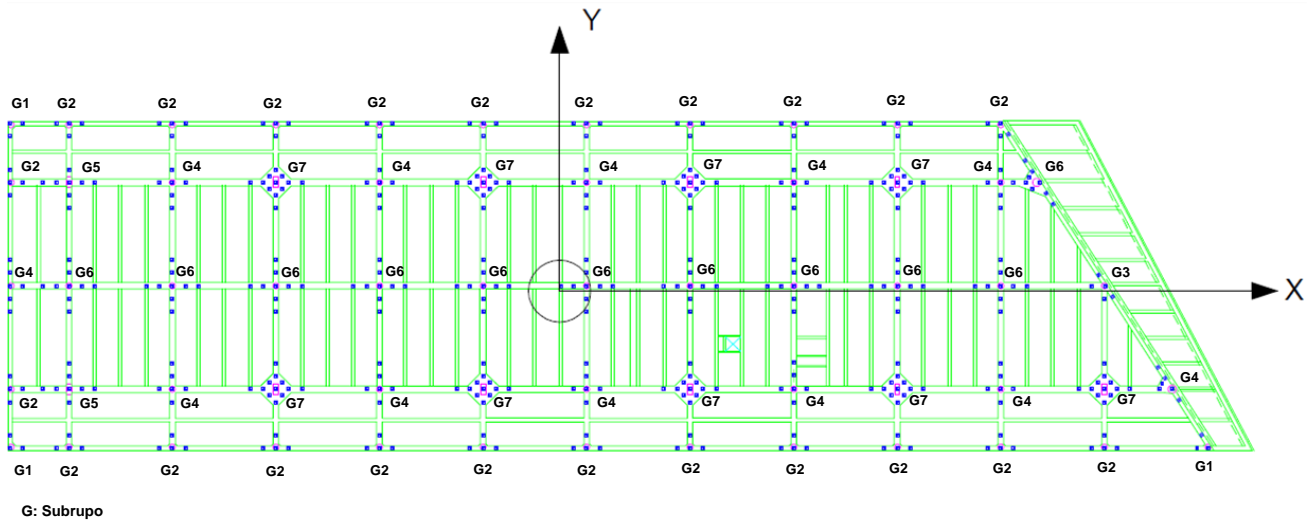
23 Distribución de los subgrupos de pilotes en planta
